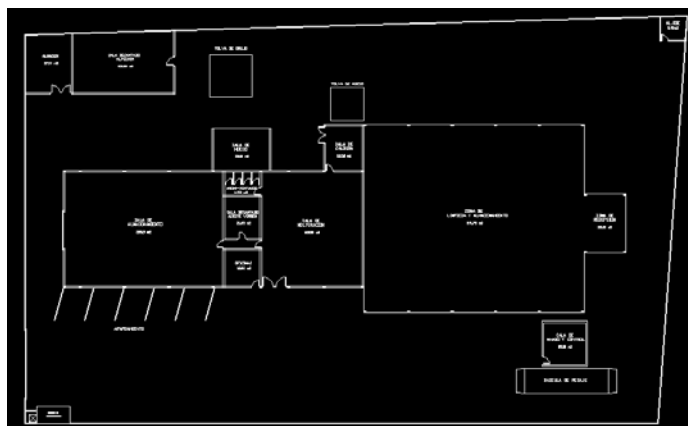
PLANTA GENERAL DE LA INDUSTRIA
